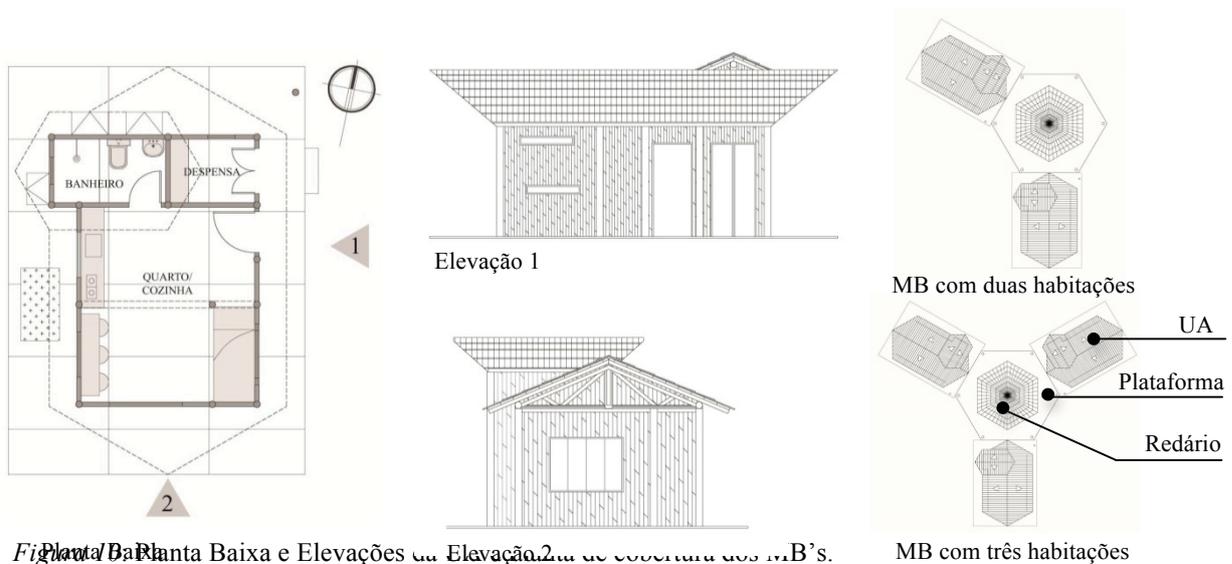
Planta Baixa e Elevações da Elevação 2 da cobertura dos M.B's.
